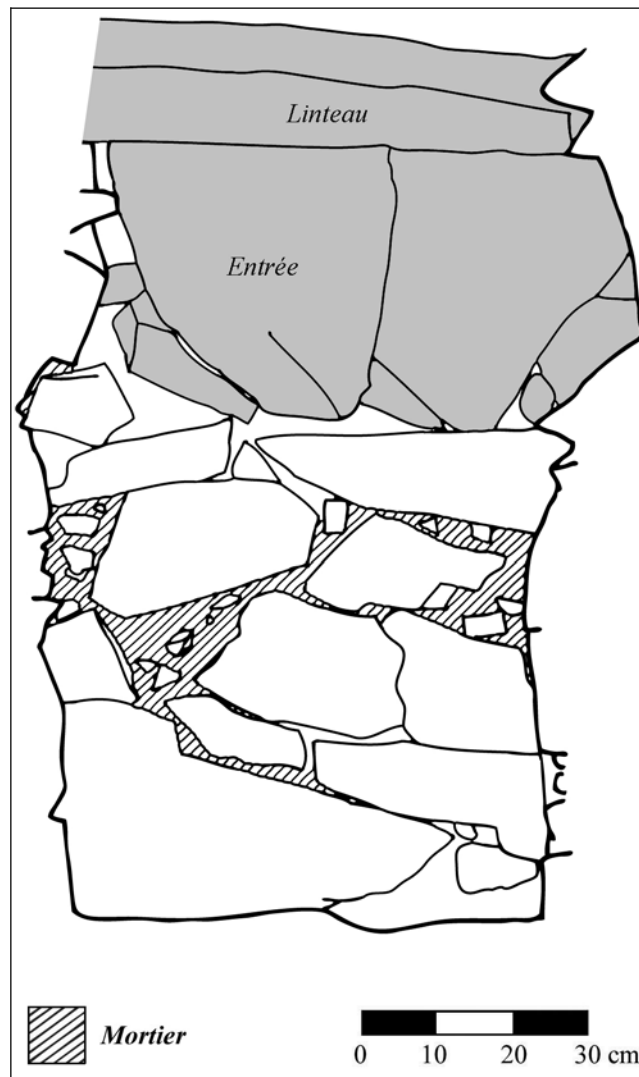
Mur de type 3. Cista 18, secteur 1° (IRA), vue intérieure en coupe du mur est. En gris, le linteau et les pierres de la « porte » (dessin R. Luna).
